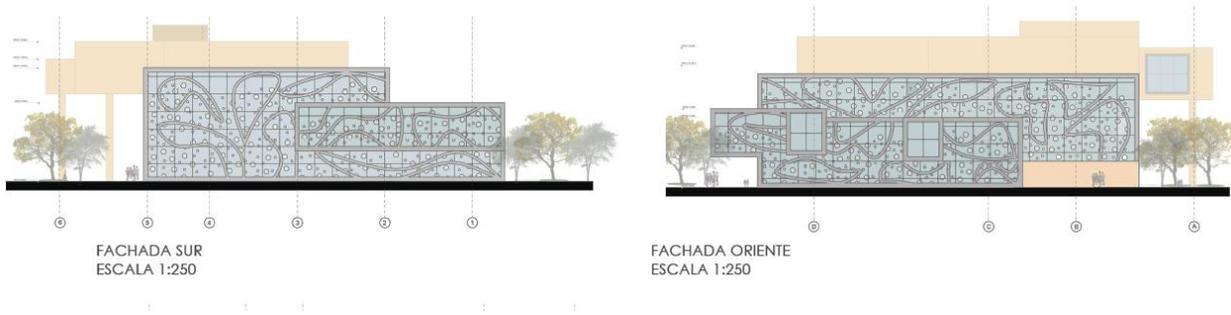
FACHADA SUR Y FACHADA ORIENTE
